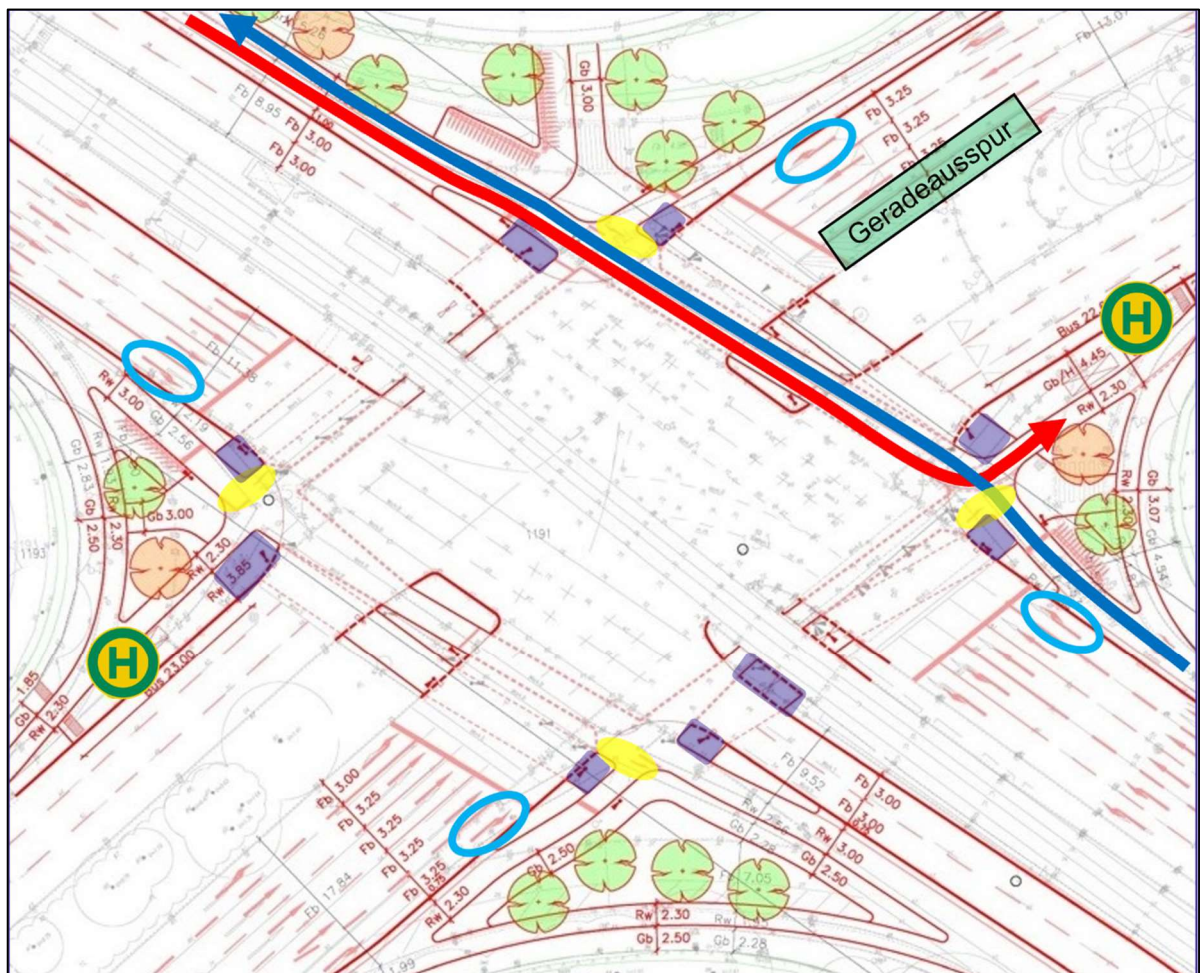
Darstellung Planungen Knotenpunkt Dachauer Straße / Wintrichring / Georg-Brauchle-Ring (Quelle: LHM 2022)
